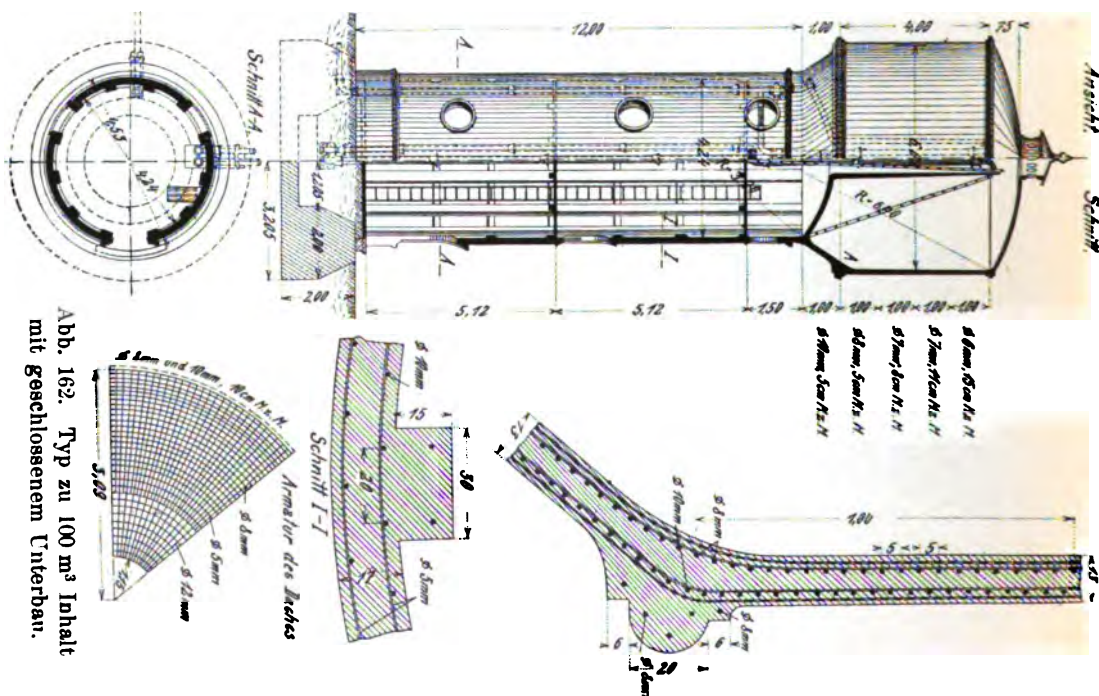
Typ zu 100 m³ Inhalt mit geschlossenem Unterbau.
